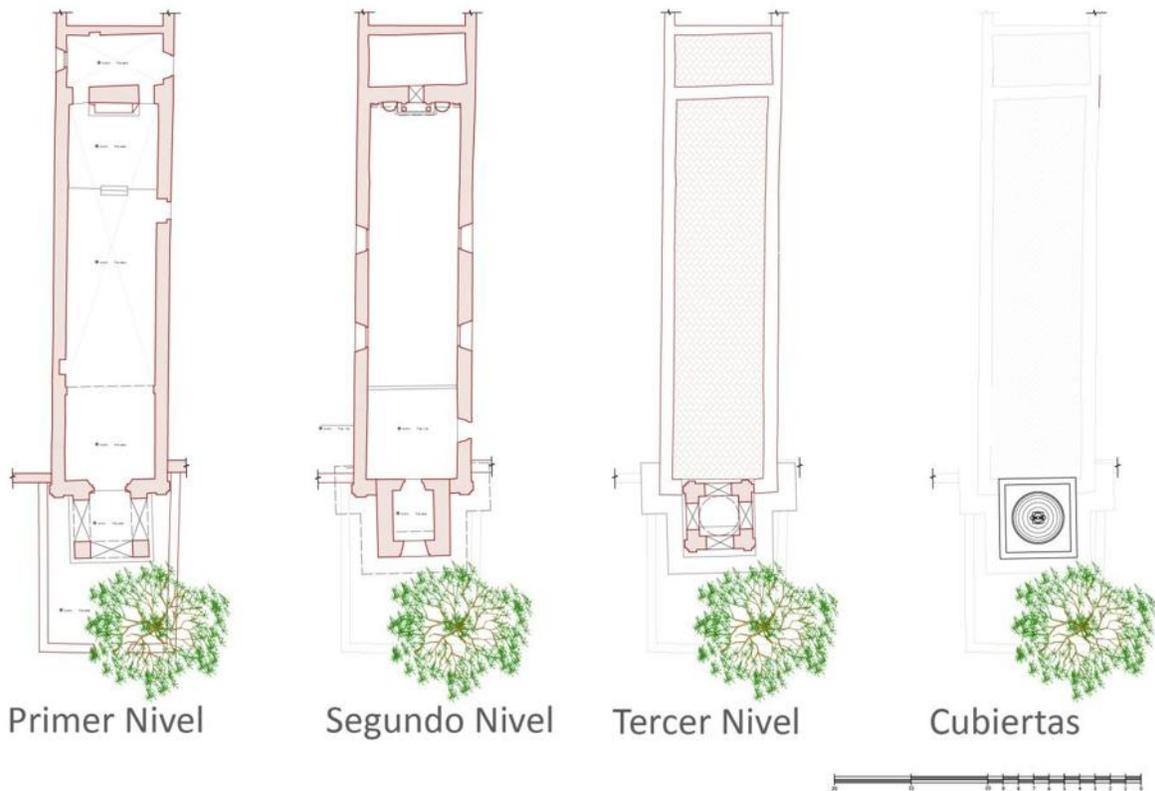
Capilla en el momento de su reconstrucción, plantas arquitectónicas - elaborado por el autor
